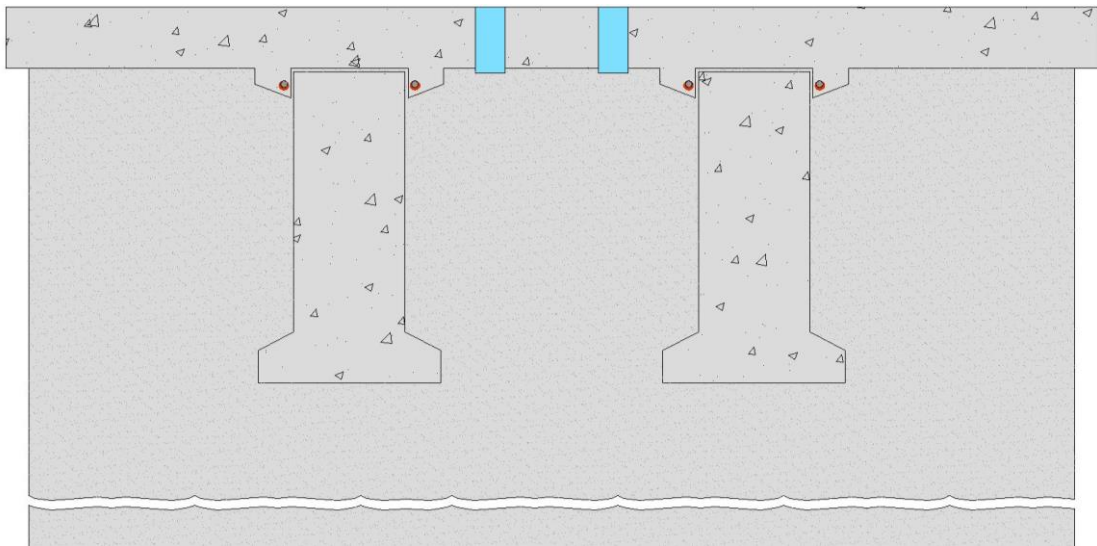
Corte da ponte das figuras anteriores com as armaduras em análise
